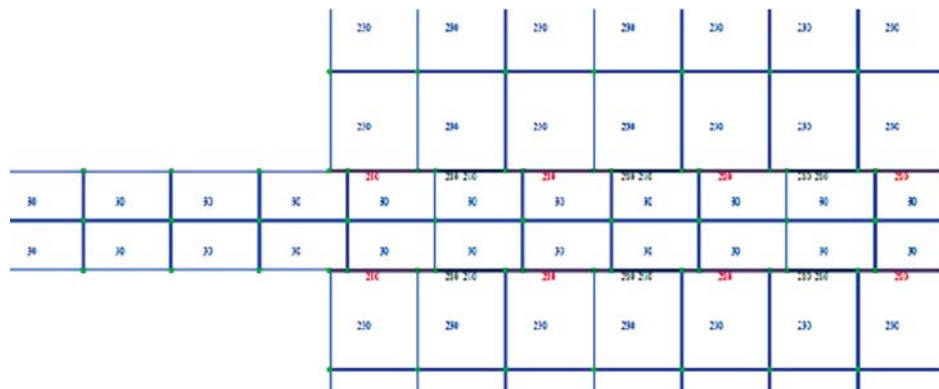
Зона контакта КЭ арматуры, бетона и ЭС, работающими на сжатие в расчетной схеме модели ПК Ли́ра-САПР
